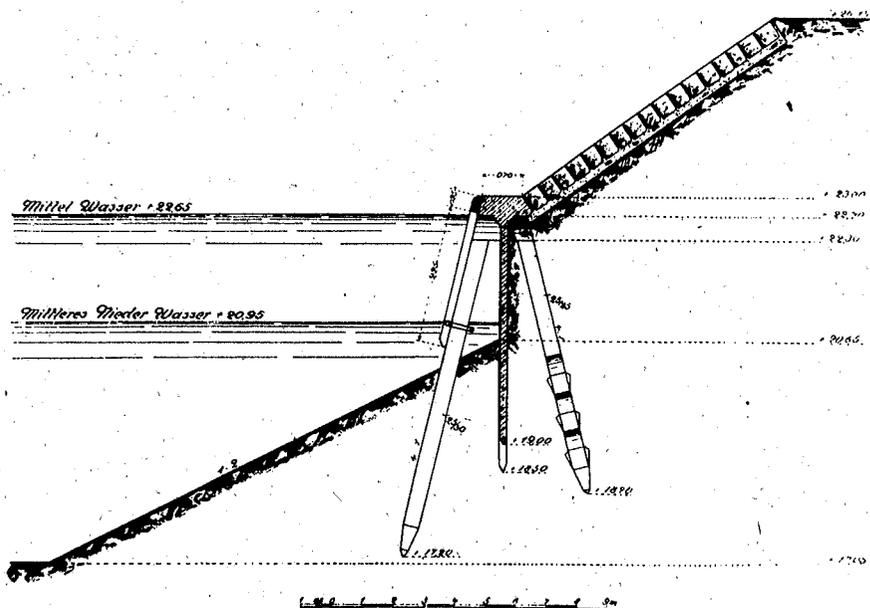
Böschung mit Betonbohlwerk im Querschnitt
